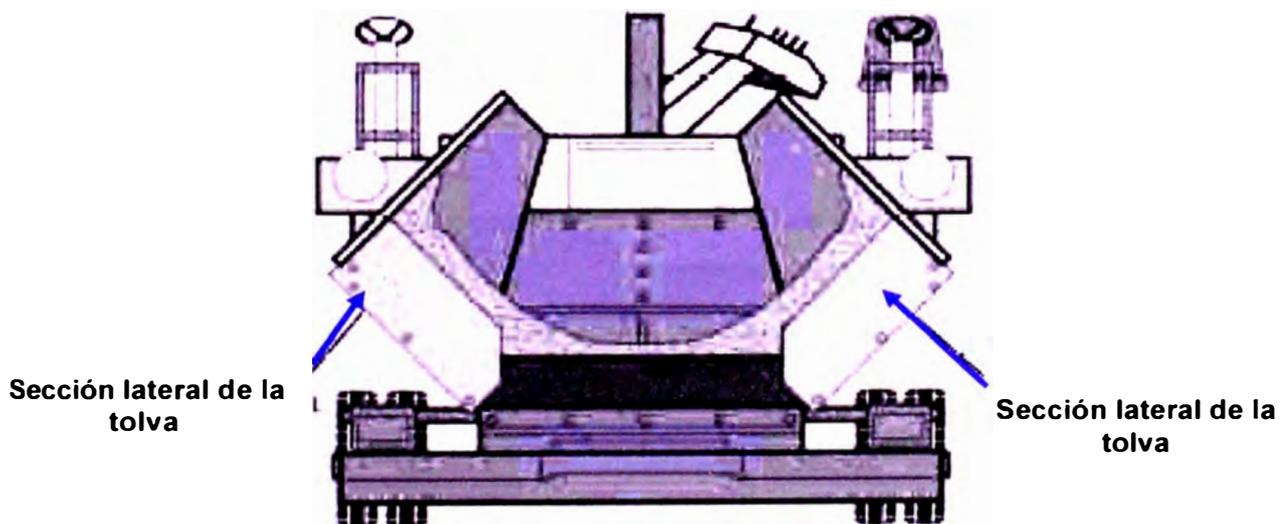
Secciones laterales de tolva de la pavimentadora
